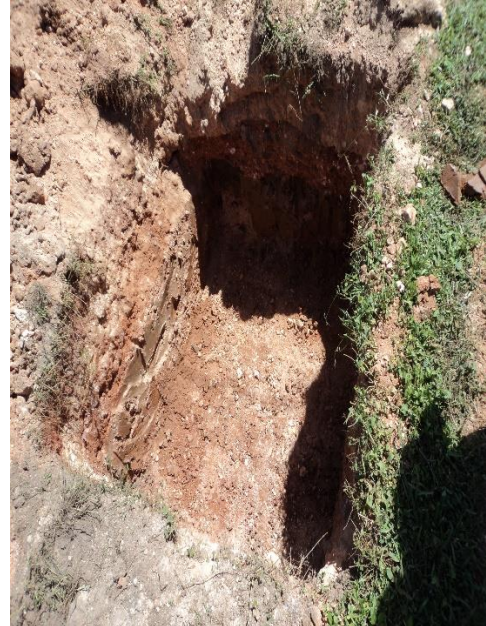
Excavación para soterrado no utilizada que ha quedado abierta en las áreas verdes de un hotel, después de que los trabajadores se han retirado luego de “concluir” el trabajo.
